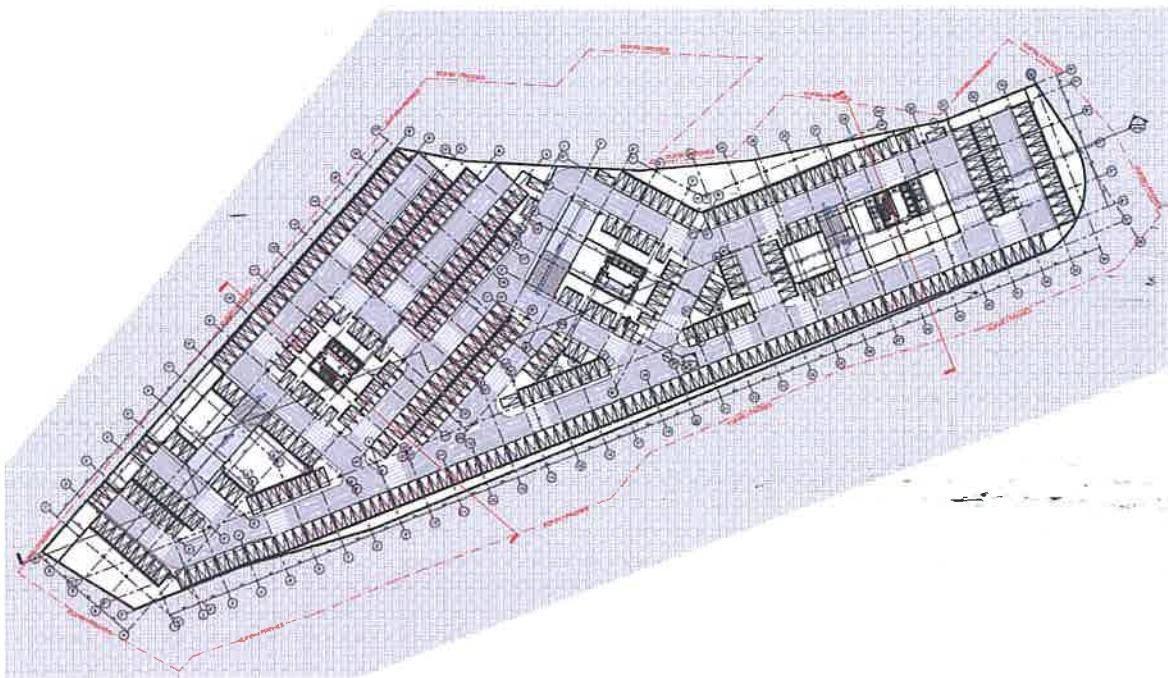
Planimetria e katit nëntokë, të parkimeve
